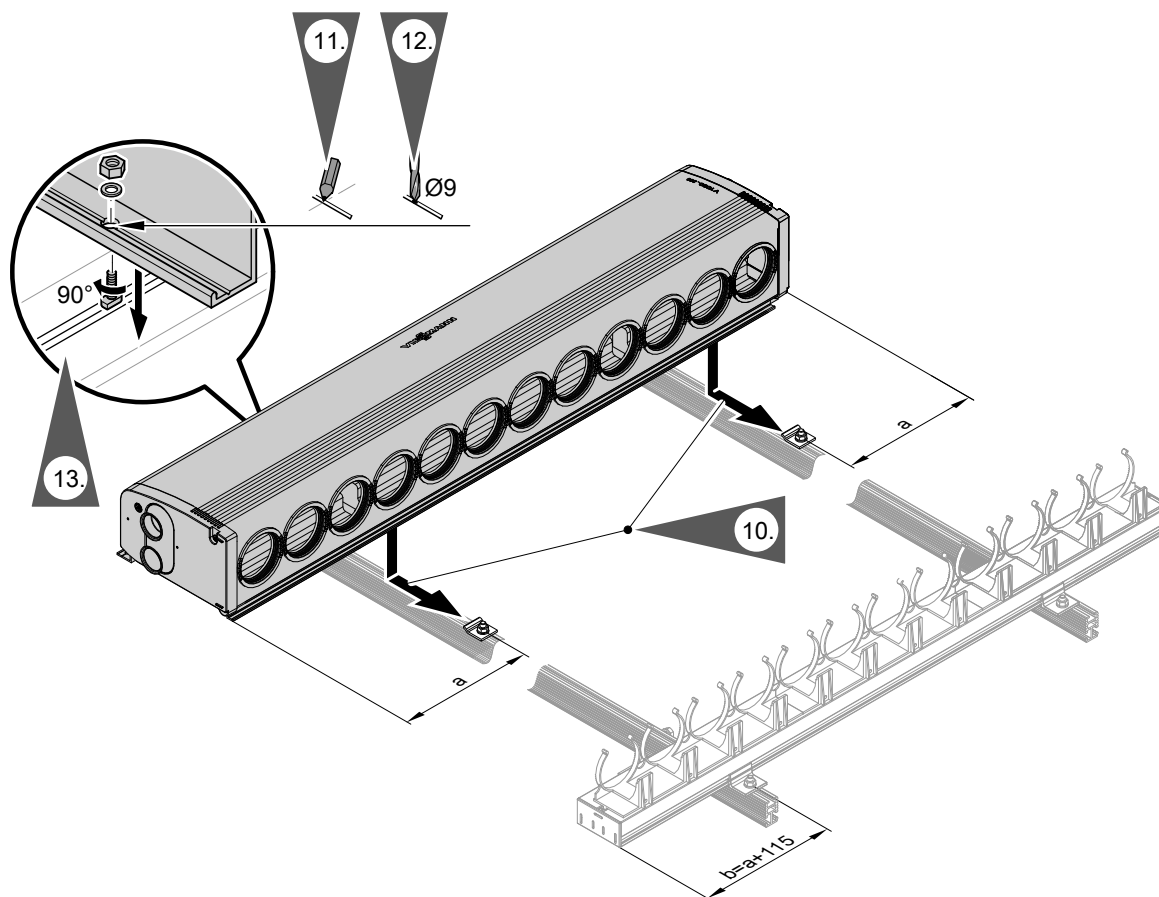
Размер a определяется после расположения соединительного корпуса по центру монтажных шин.
